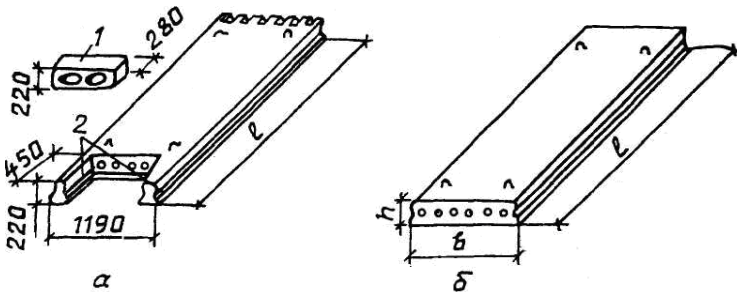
Великорозмірні збірні залізобетонні конструкції перекриттів:
